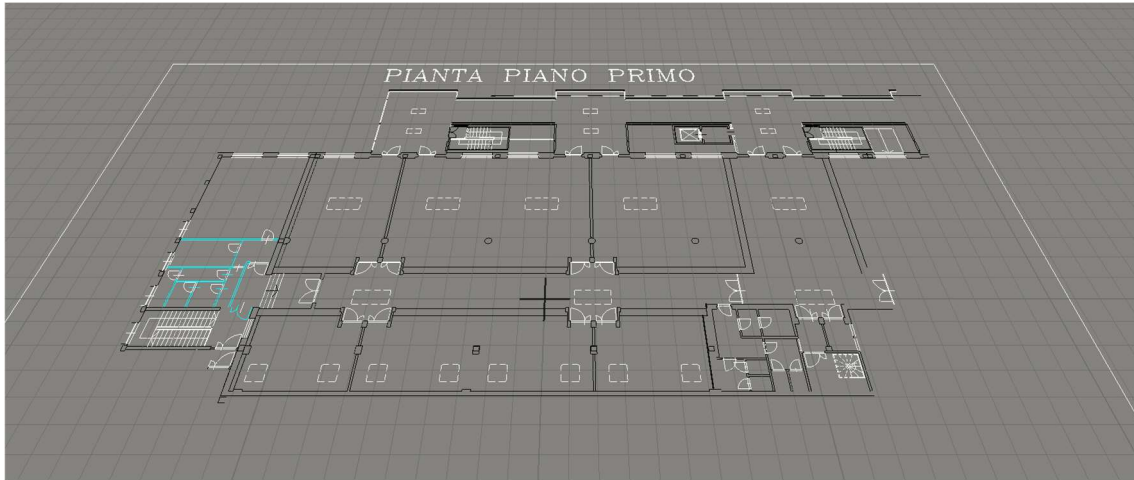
Planimetria dell'intero piano in cui è situato il laboratorio LEP.
